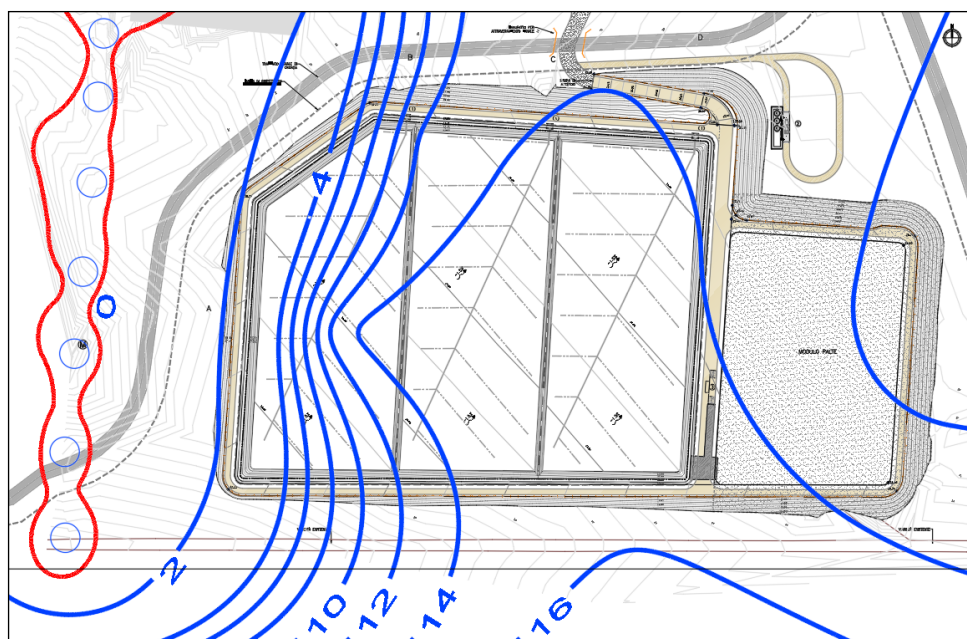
Planimetria Sito di Raccolta (SdR) e Modulo Palte Fosfatice (MPF) con indicazione della falda statica.
